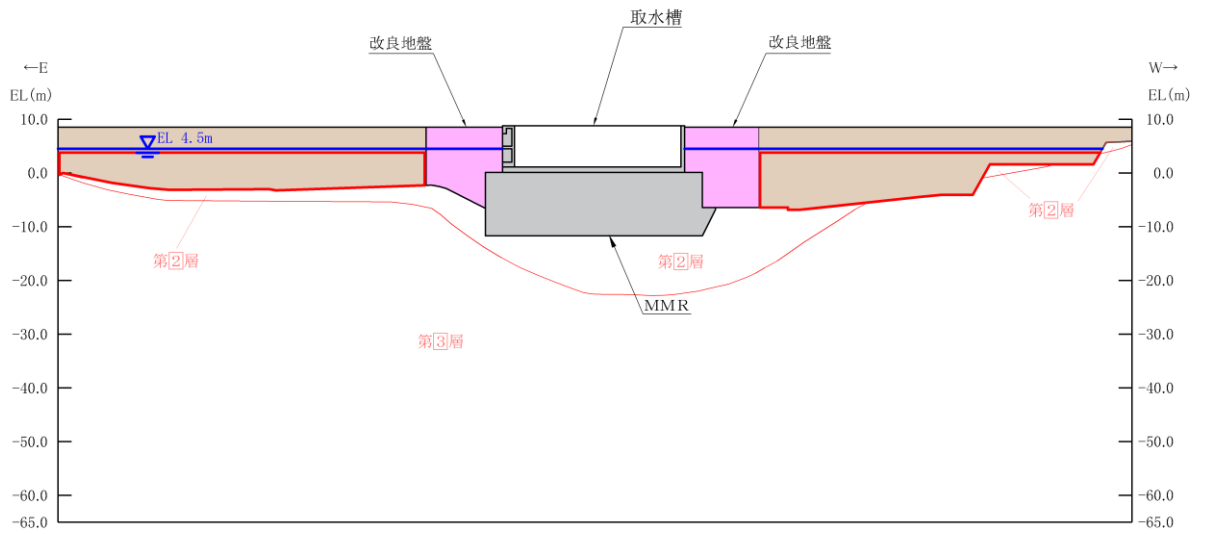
取水槽 地震時荷重算出断面図 (B-B 断面)
